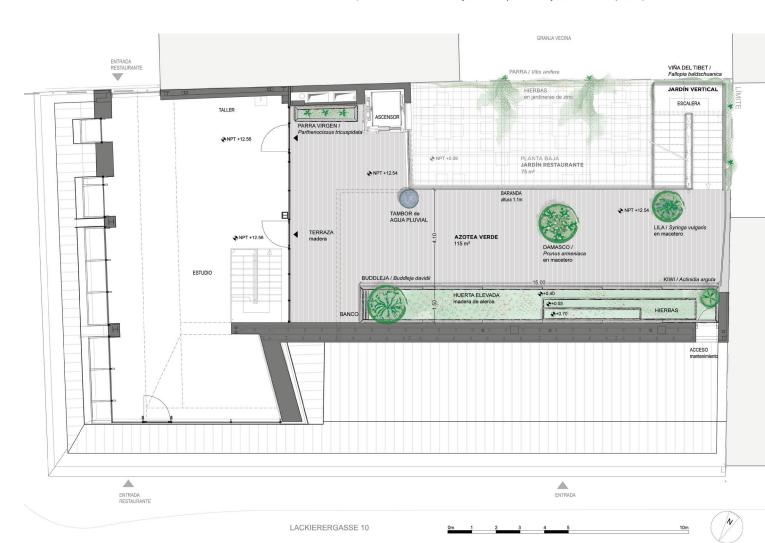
Plano de la azotea verde (fuente: Elaboración propia en base a un plano de gaupenraub+/-).
